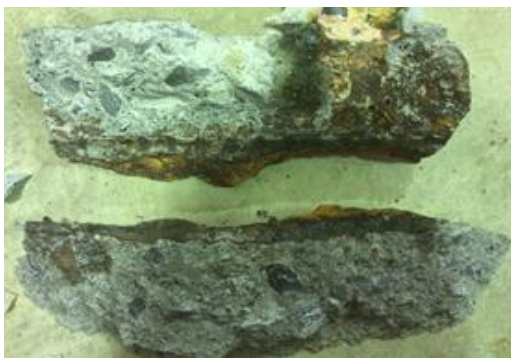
最終腐食ひび割れ性状
